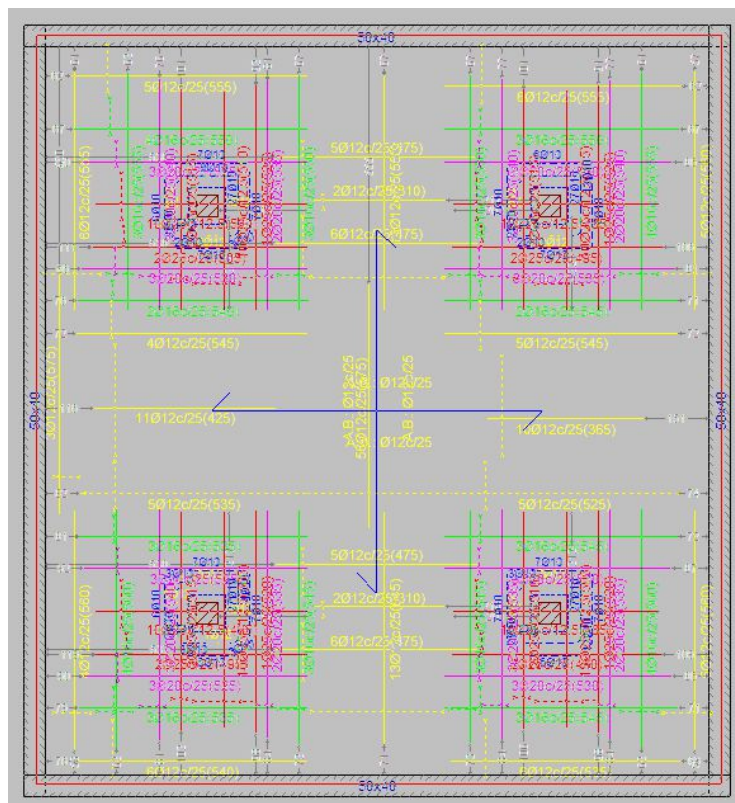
Losa de cimentación. Vigas perimetrales y armado. Fuente CypeCad
